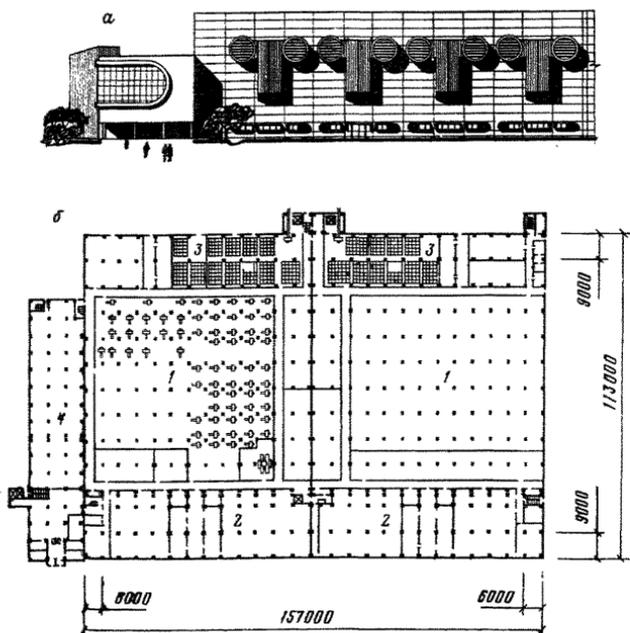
Вынос инженерных коммуникаций на фасад многоэтажного производственного здания (а) и план первого этажа (б)
